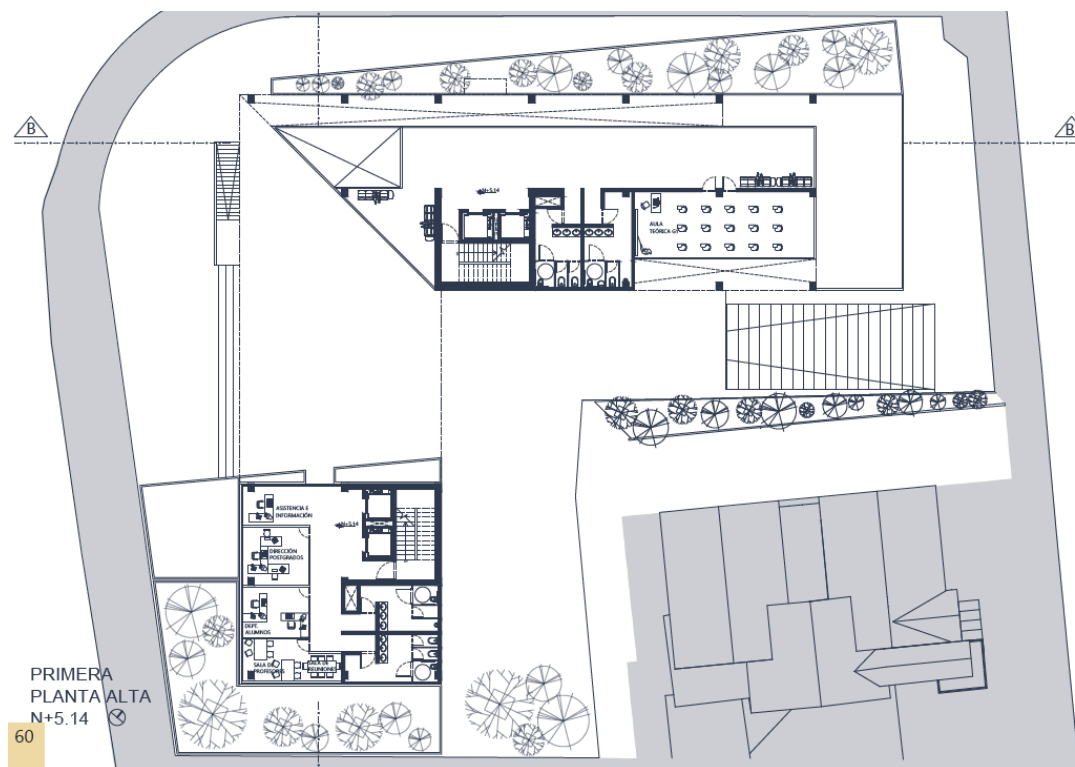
Primera Planta Alta N+5.14. Autoría propia
